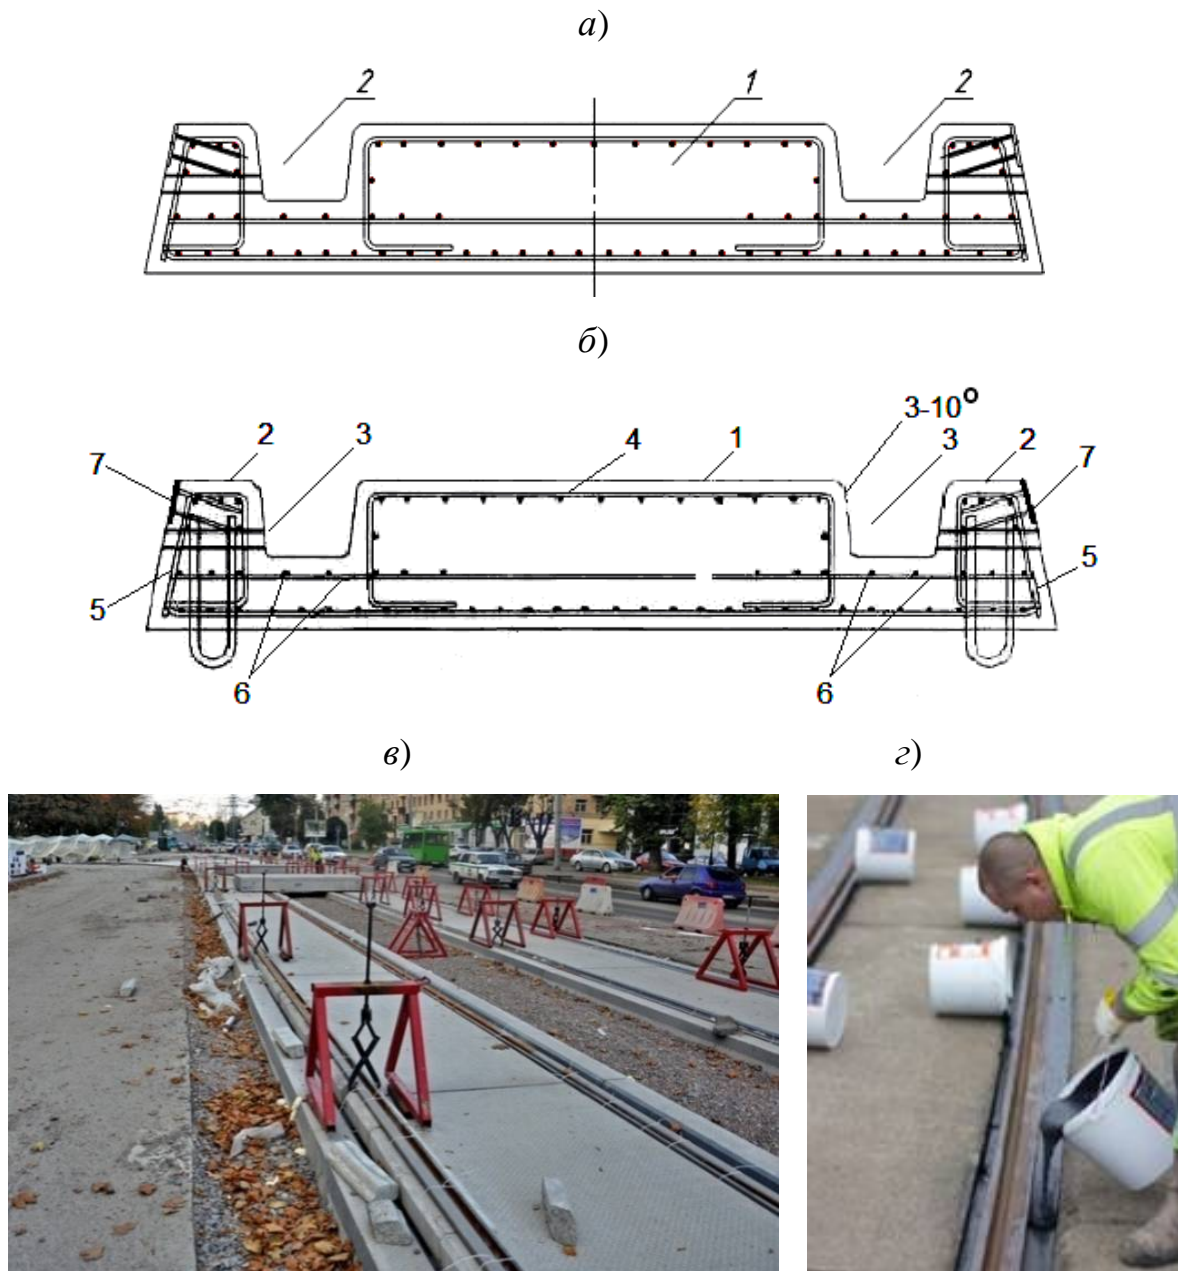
Конструкція трамвайної колії зі збірною підрейковою основою із залізобетонних плит з ізолюваними рейками: *а* – поперечний переріз плити: 1 – плита, 2 – рейковий канал; *б* – те ж саме плити з монтажними петлями: 1 – середня частина плити; 2 – бічні частини плити; 3 – рейкові канали; 4 – арматурний каркас, незамкнений знизу; 5 – арматурний каркас в бічних частинах плити; 6 – окремі арматурні стержні в місцях каналів; 7 – закладні деталі; *б* – встановлення рейок з прирейковими вкладишами у рейкові канали перед заливанням мастики (м. Харків, пр. Московський, 2016 р.); *в* – заливання поліуретанової мастики в зазори між стінками рейкового каналу і рейкою
